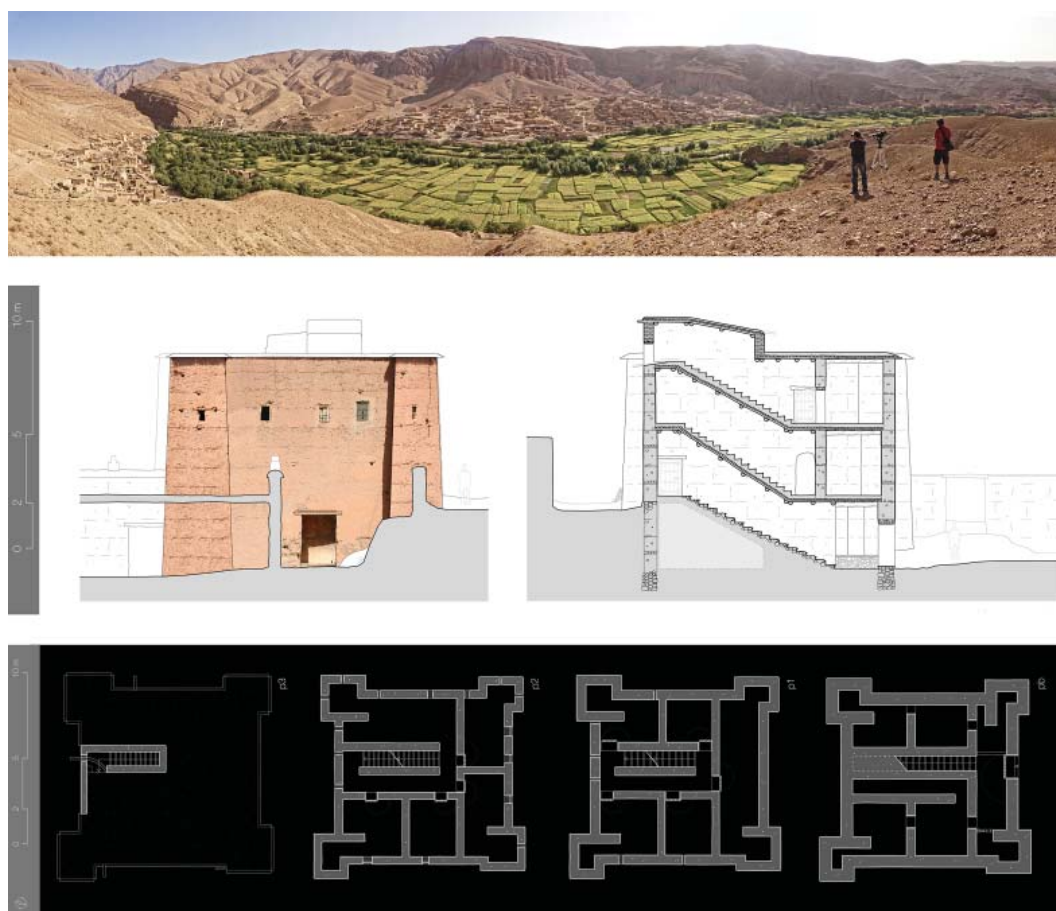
Kasbah Ait Boussaka. Valle con kasbah en el centro. Alzados sur y sección. Plantas. Fuente: Grupo UPV.
